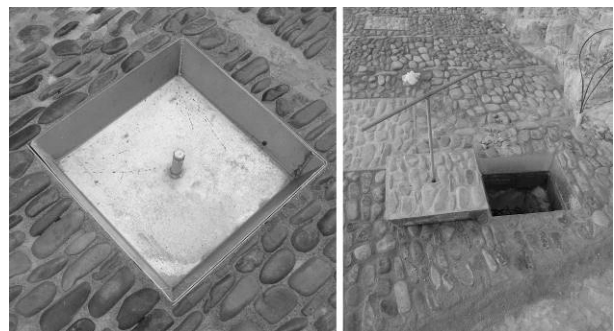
Imagen de una de las trapas de registro antes y después de darle el acabado final igual al pavimento.
